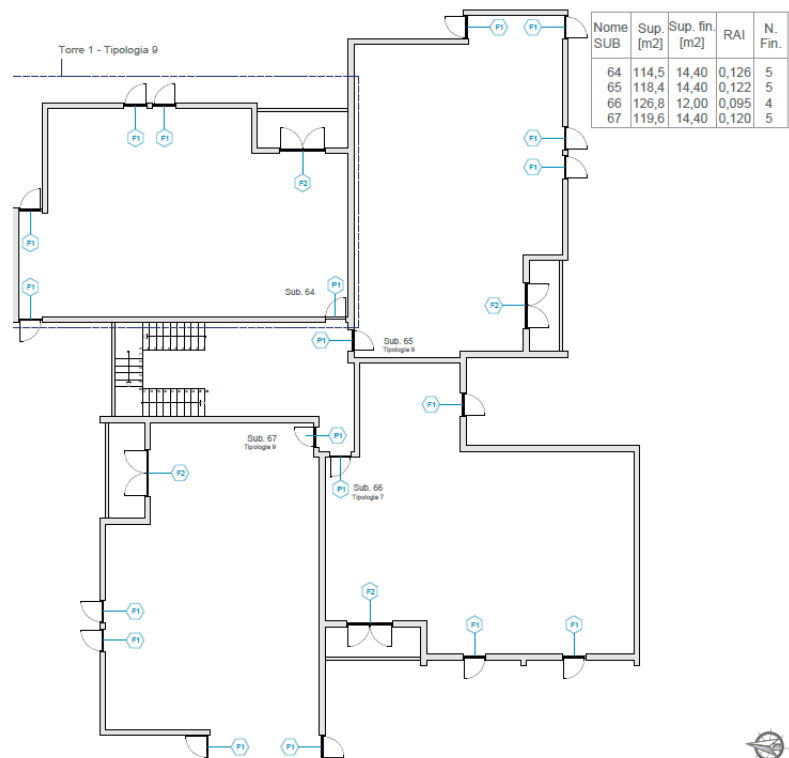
Pianta stato di fatto, piano settimo- Torre 1
